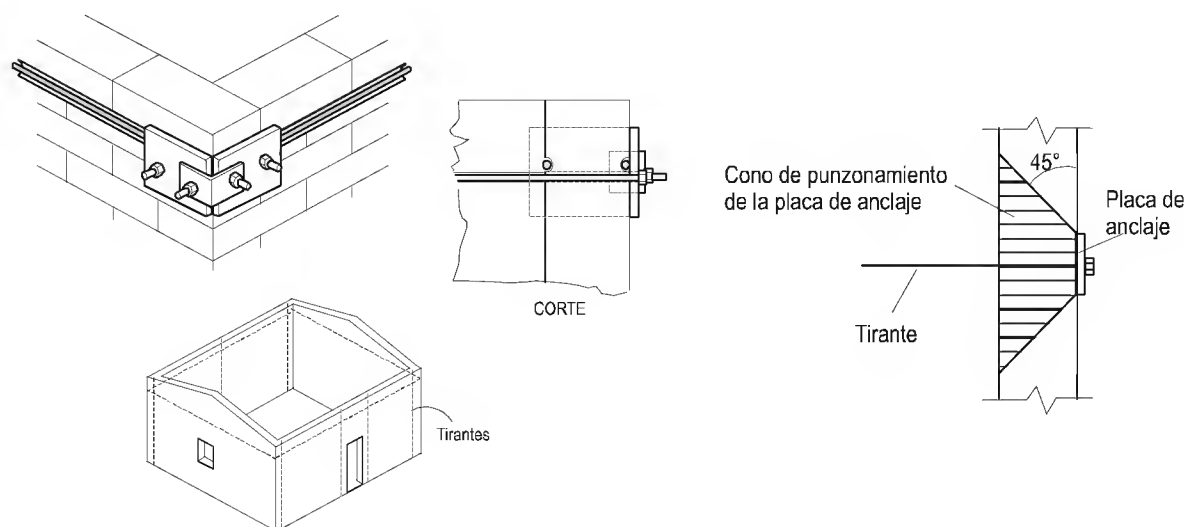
Amarre de muros de adobe con tensores metálicos
